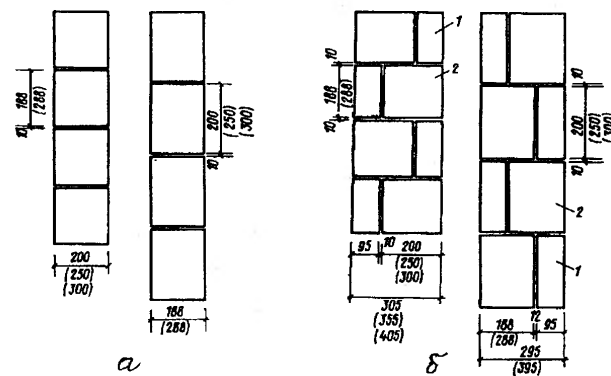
Кладка из ячеистобетонных камней: а – стены толщиной в 1 камень; б – стены с перевязкой чередованием целых камней и продольных половинок; 1 – продольная половинка; 2 – целый камень
